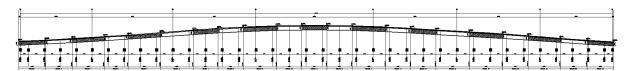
Sovrappasso di uscita – sezione longitudinale trave esterno curva
